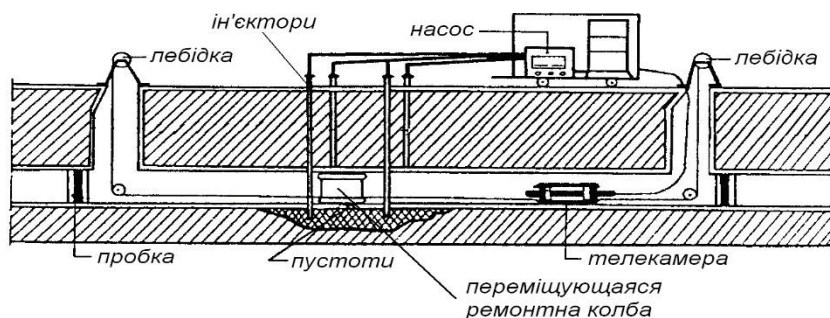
Схема ін'єкування зовнішньої поверхні трубопроводу
